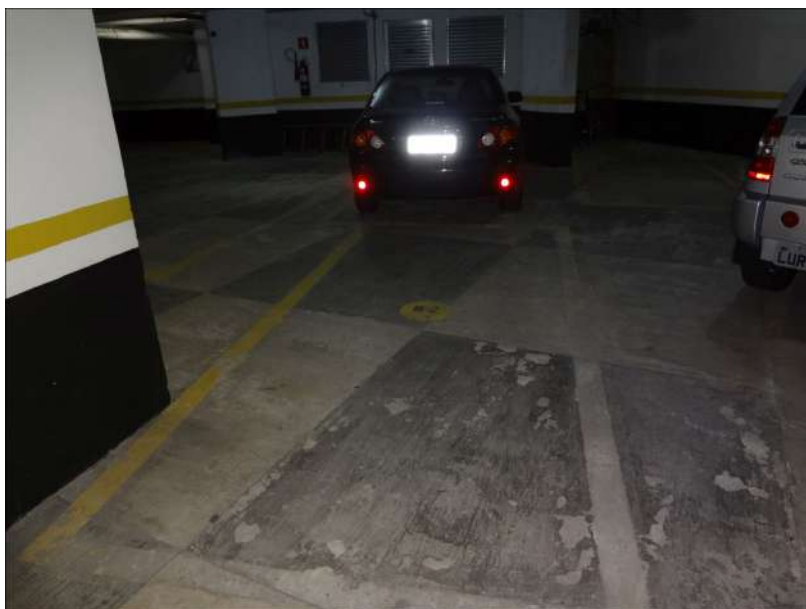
02 (duas) vagas conjugadas do apartamento 102.
